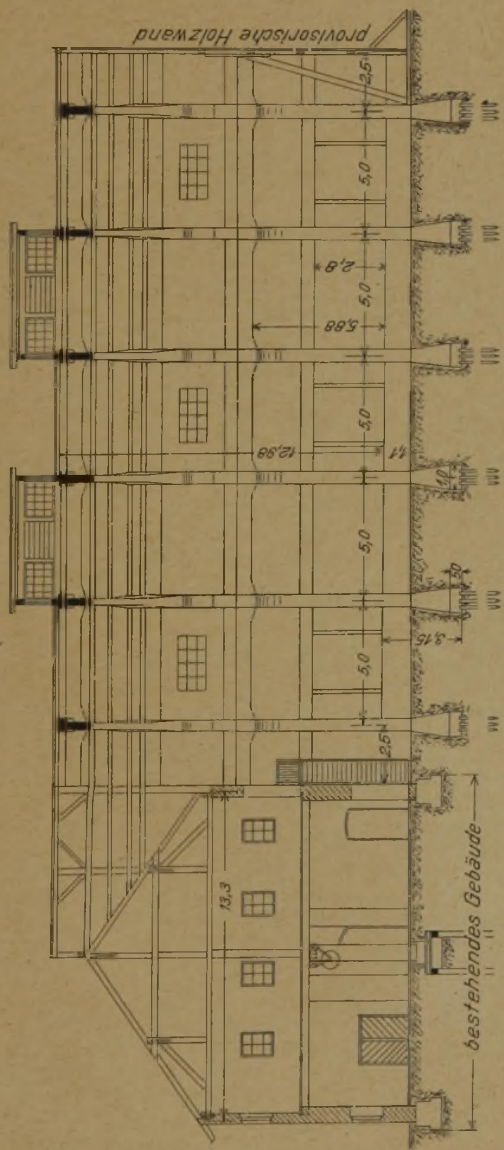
Längsschnitt des Hallenbaues. (1 : 300.)
